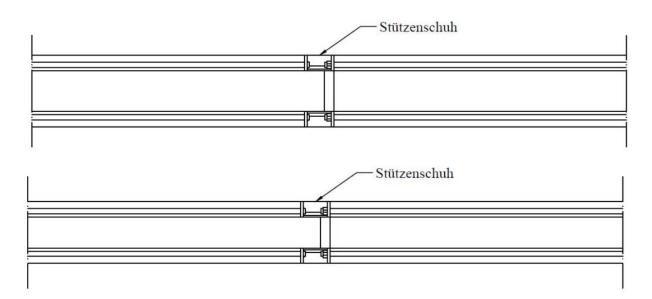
Prinzipskizze des nachträglichen Stoßes der Bewehrung mittels Stahleinbauteil und Verschraubung
